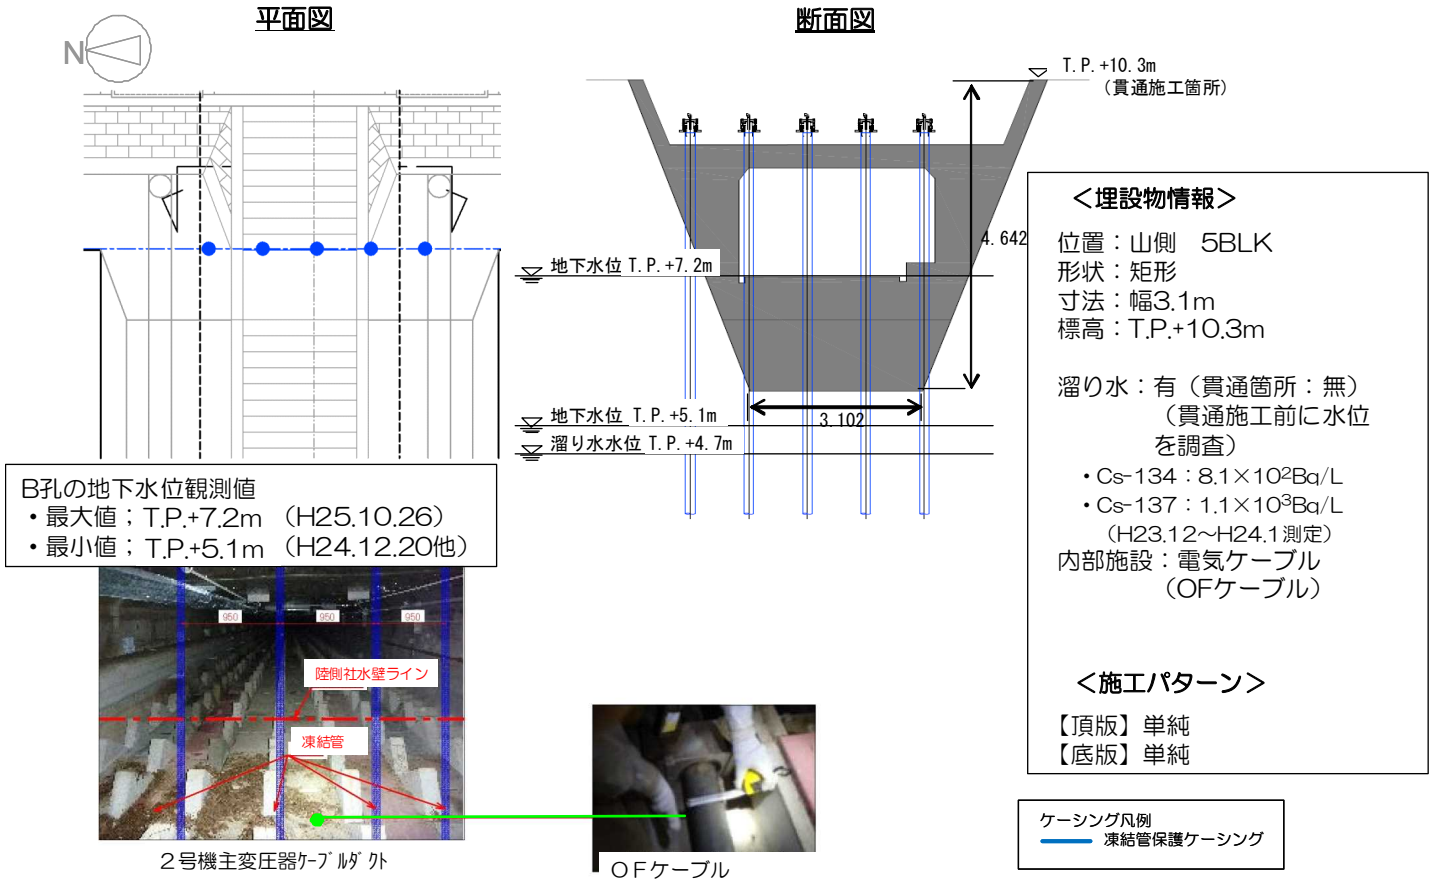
【5-1】1号機電気ケーブルダクト 施工方法 (貫通施工)
